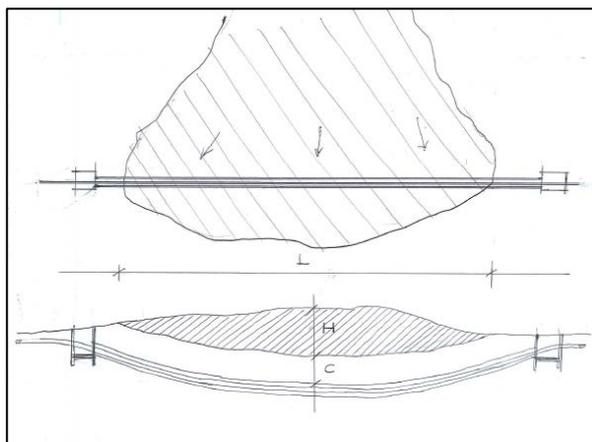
/A – Schema di un attraversamento “Trenchless” sotto la superficie di scorrimento del movimento franoso.
